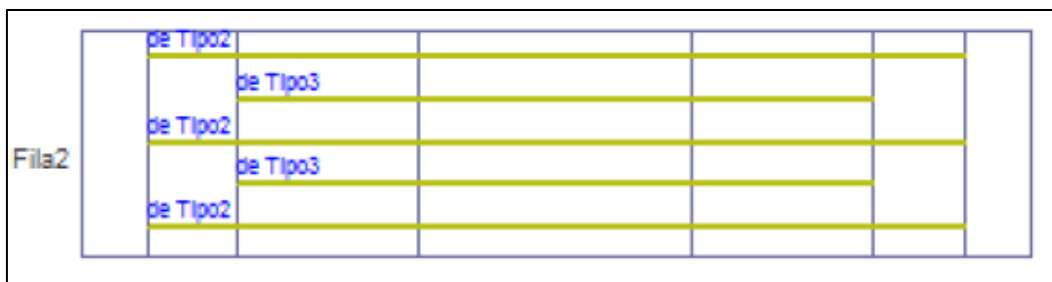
Detalle del despiece en la sección longitudinal de una viga.
